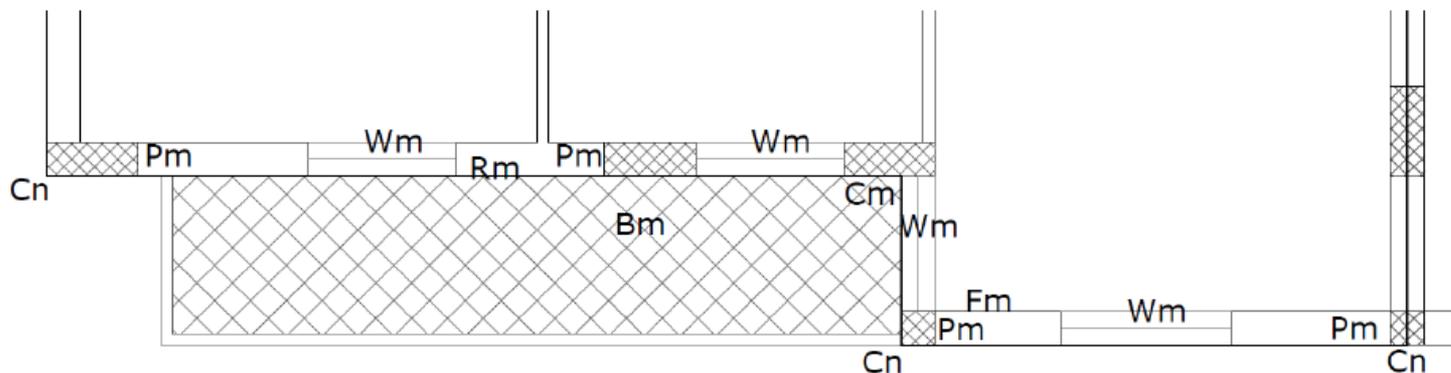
Dettaglio del ponte termico – tipo angolo – con strato isolante principale nella parte intermedia. Prospetto 2 dell'UNI EN ISO 14683.
